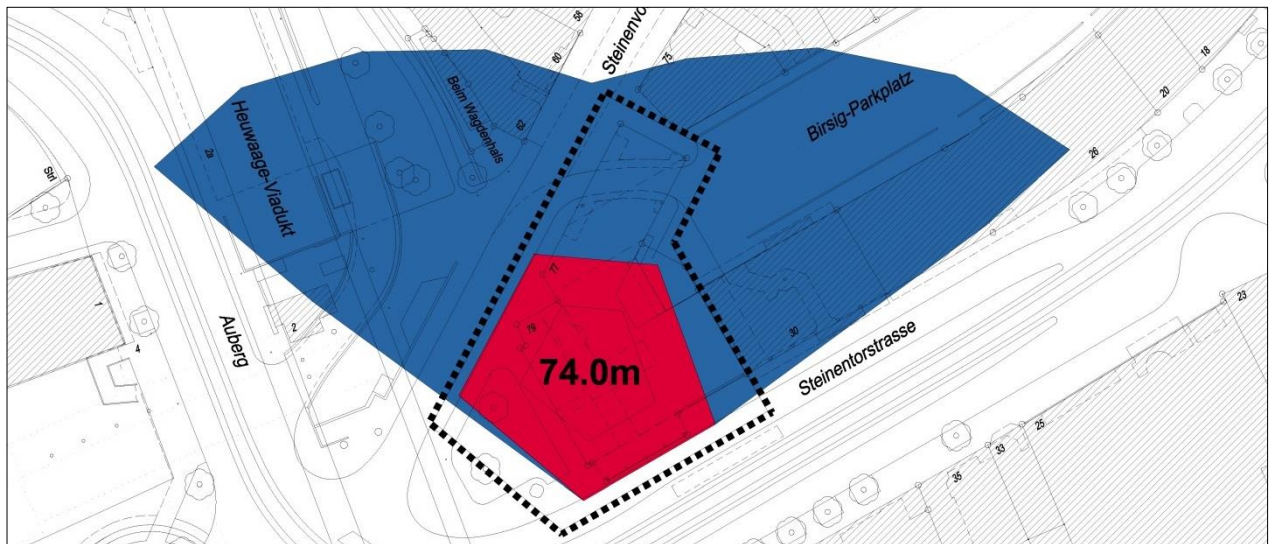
Zwei-Stunden-Schatten des geplanten Hochhauses. Höhe = 74 m. (Kein Massstab, Plan genordet)
